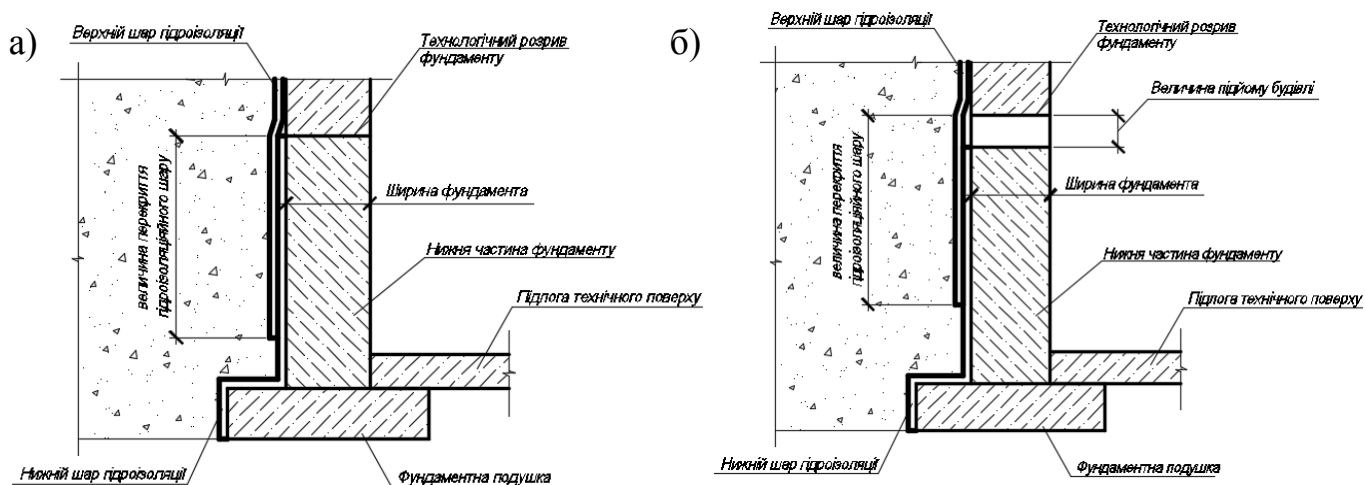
Розріз по фундаменту з проектною величиною перекриття гідроізоляційного шару: а – до вирівнювання будівлі; б – після вирівнювання будівлі.
